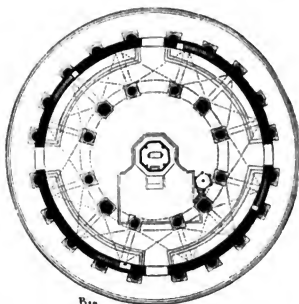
Grundriss des Baptisteriums zu Pisa. (Nach Gallhabaud.)
